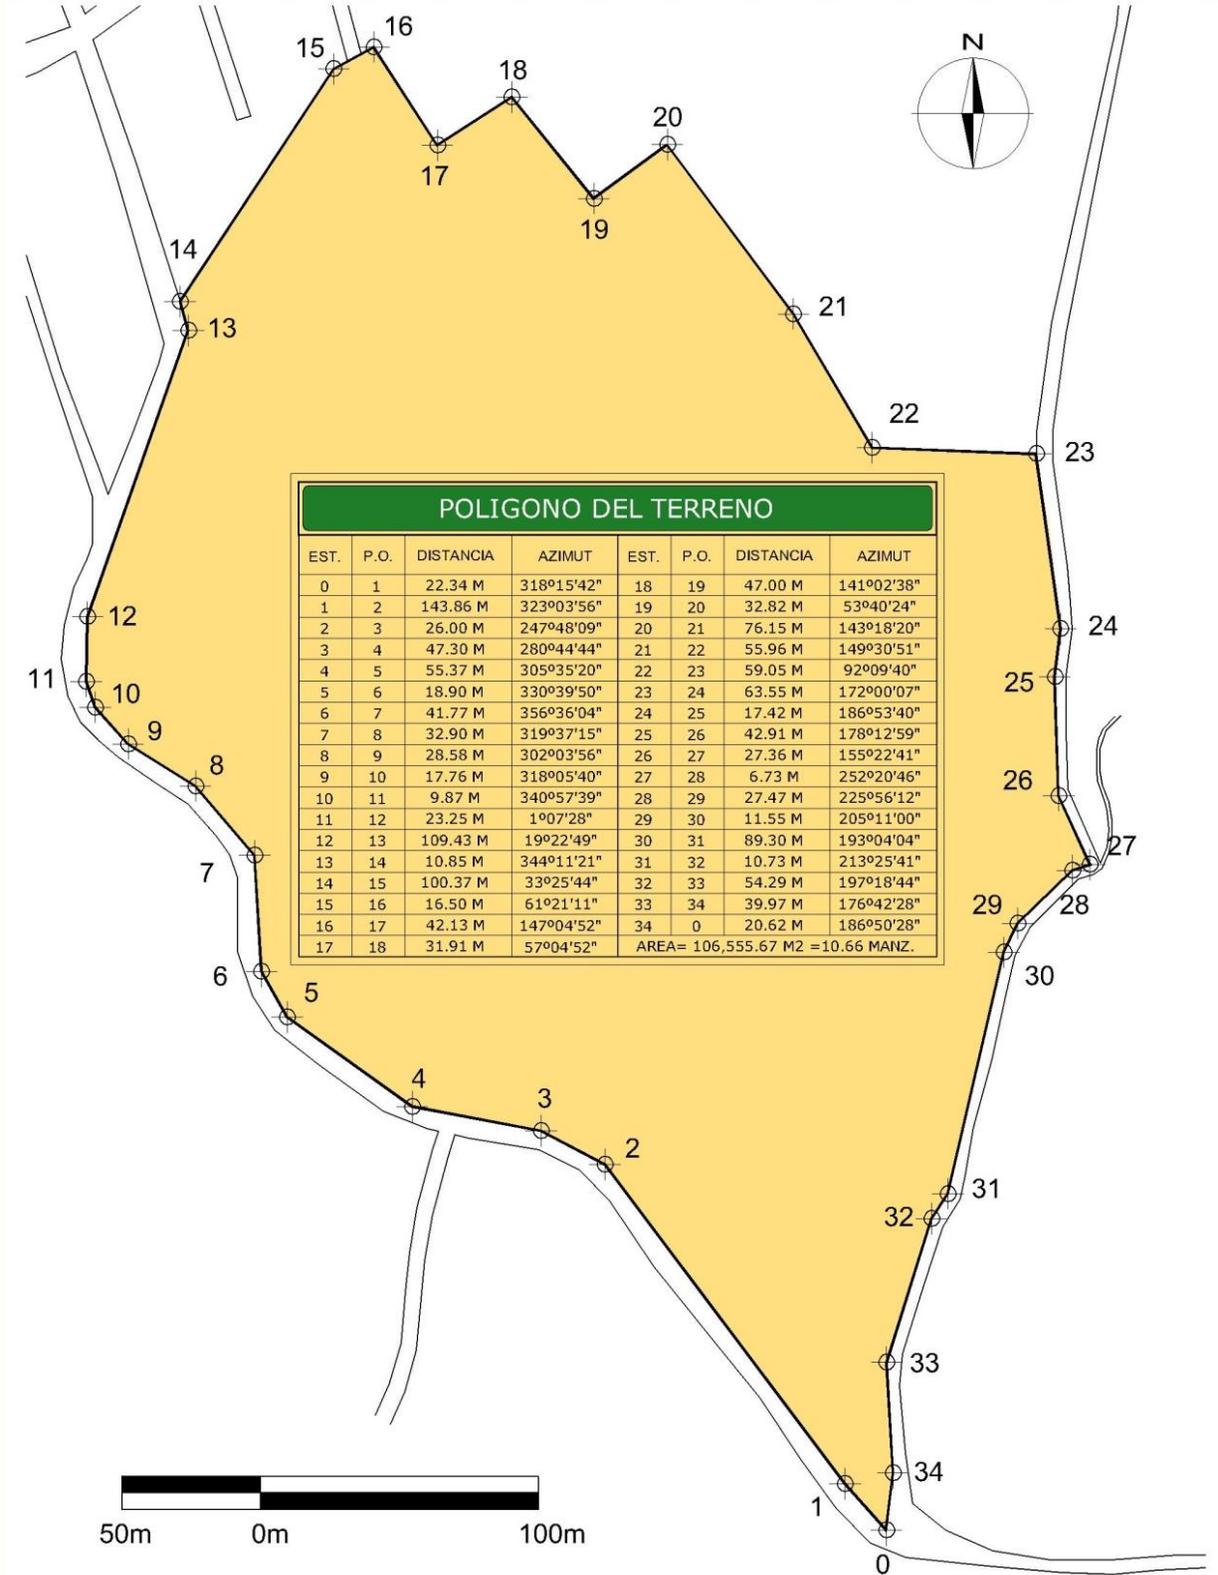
Plano de polígono del terreno. Fuente: elaborado por M. Ochoa Morales.
